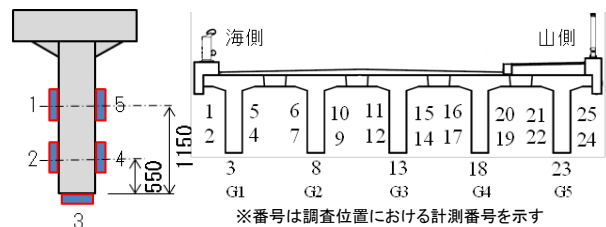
ガーゼ拭き取り法計測位置断面図
